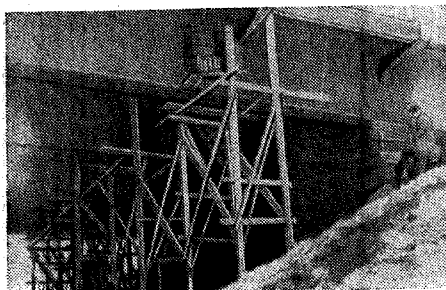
Крепление зарядов ВВ к главным балкам железобетонного моста.
